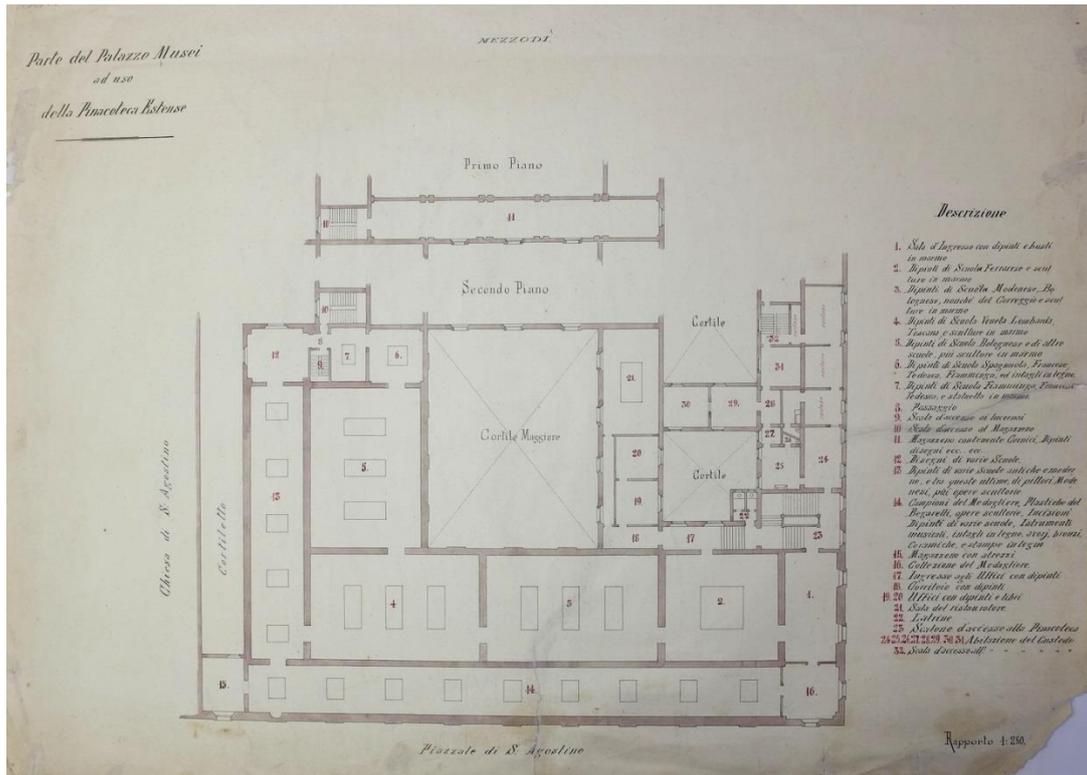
Pianta del museo con la sistemazione di Adolfo Venturi e Giulio Cantalamessa, Archivio Galleria Estense
